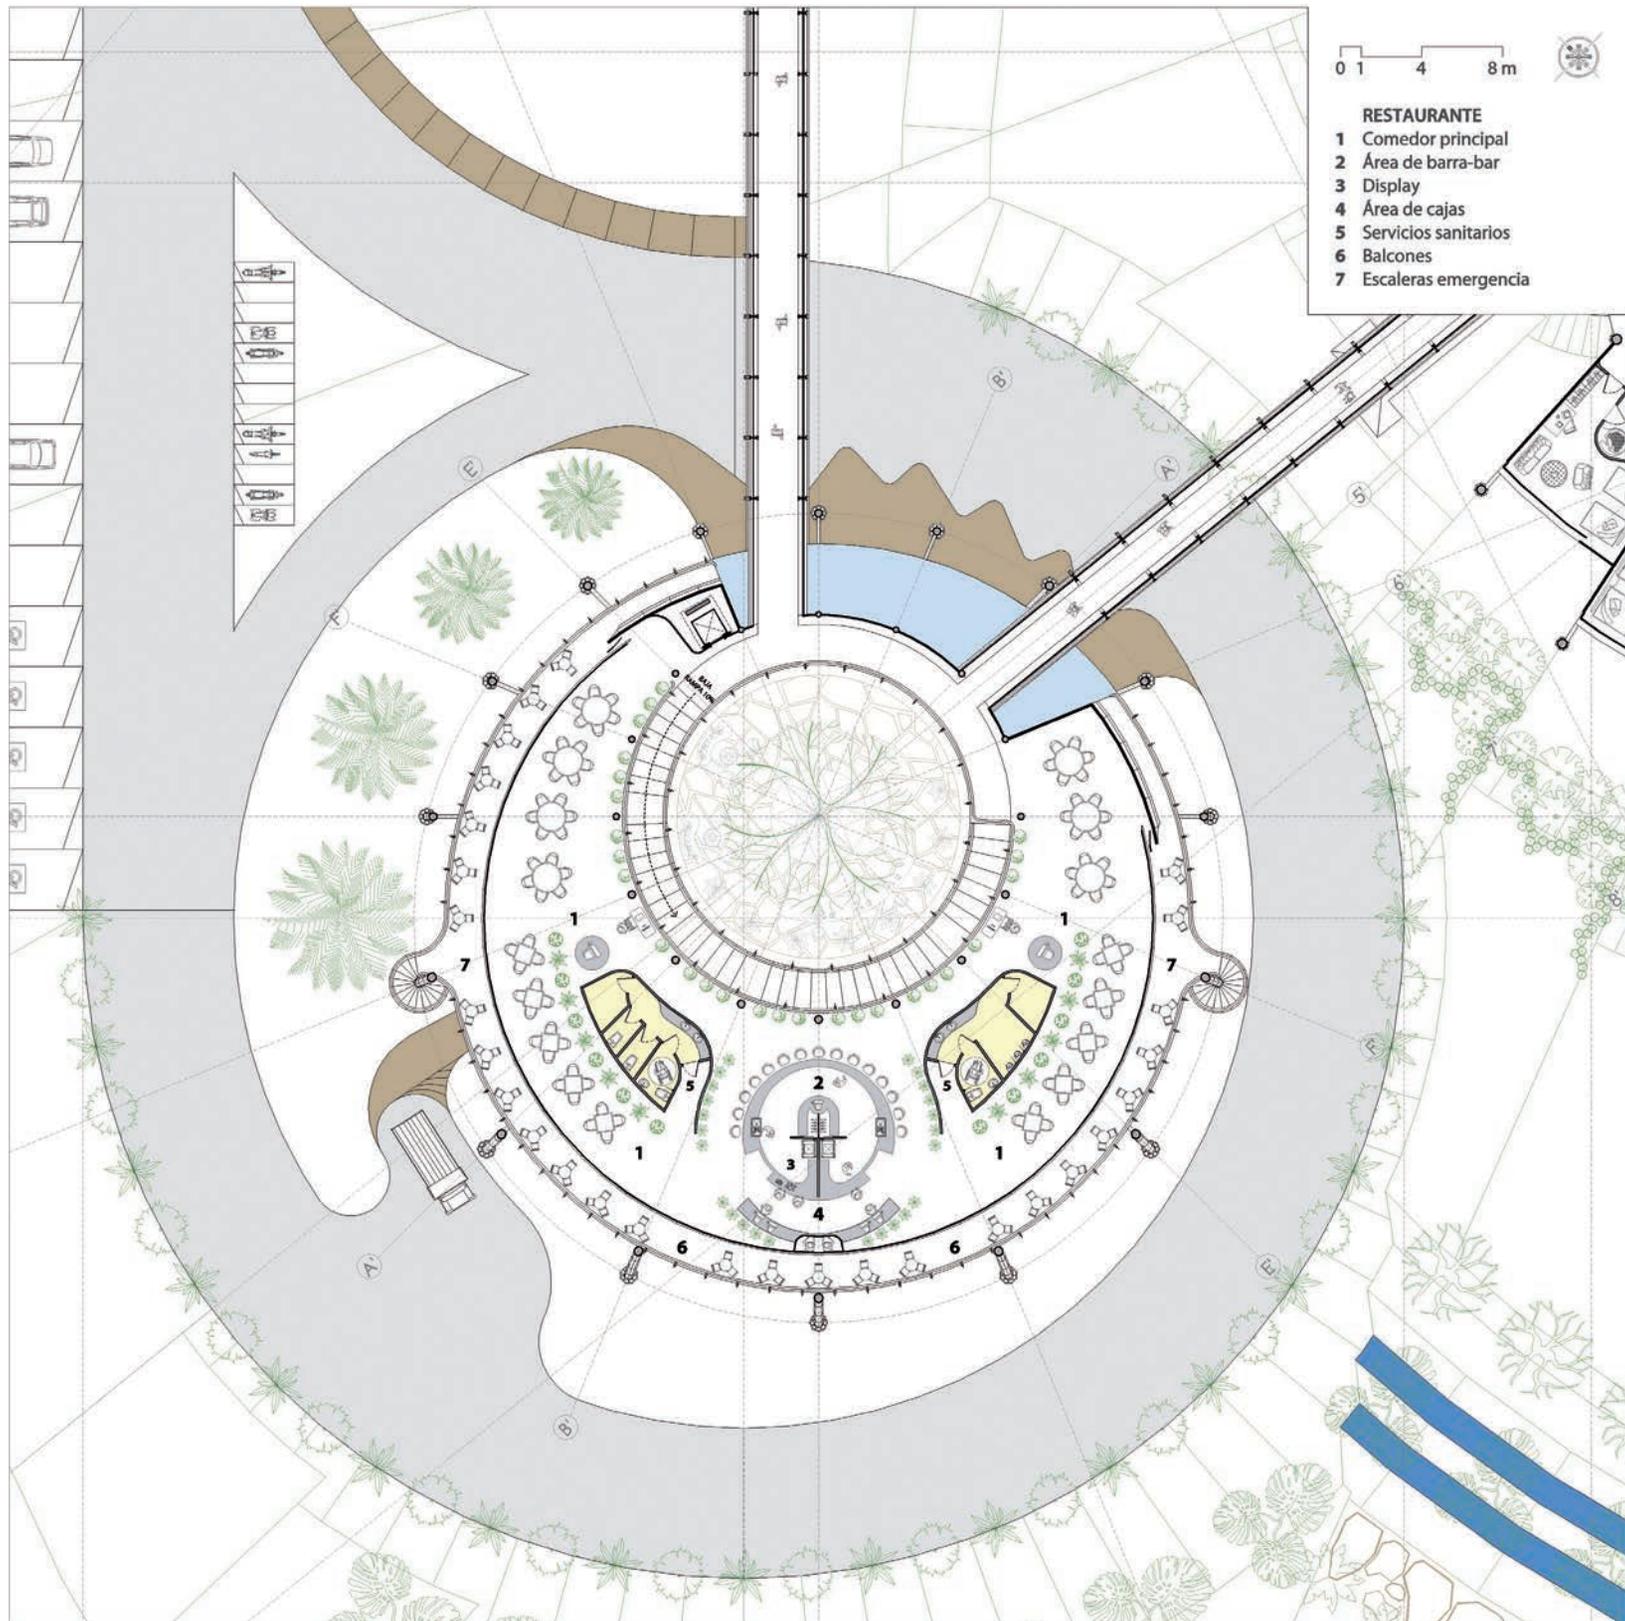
Planta Arquitectónica del Restaurante, Nivel 2, 0+5,85 m snpt.
